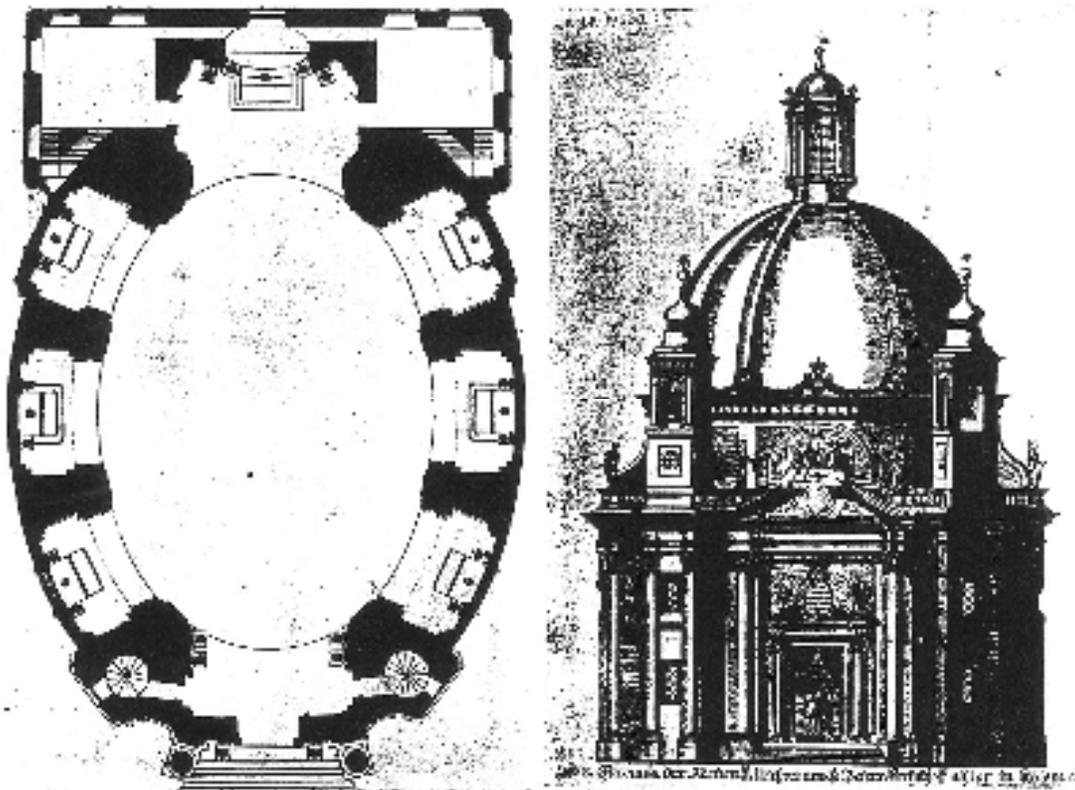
St. Peter in Wien, Stiche nach dem ursprünglichen Projekt für den Neubau der barocken Peterskirche des Architekten Gabriele Montani, Grundriss und Aufriss der Fassade, aus einem Sammelbrief von 1701.
